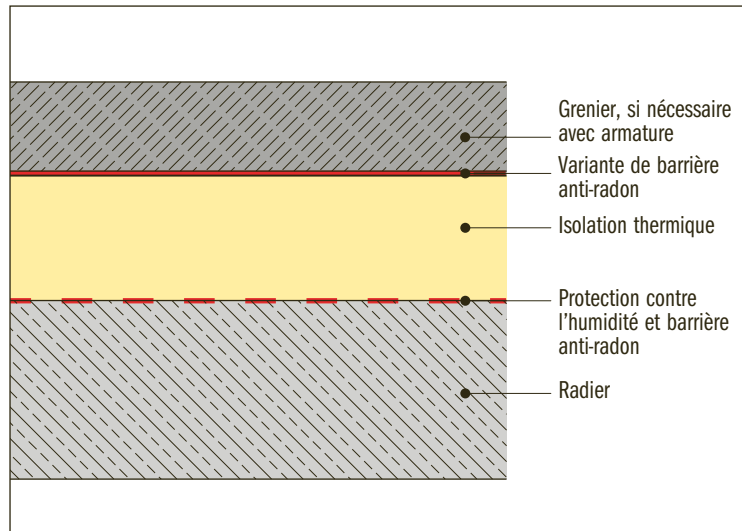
Structure du sol classique (source : Dow Building Solutions).
